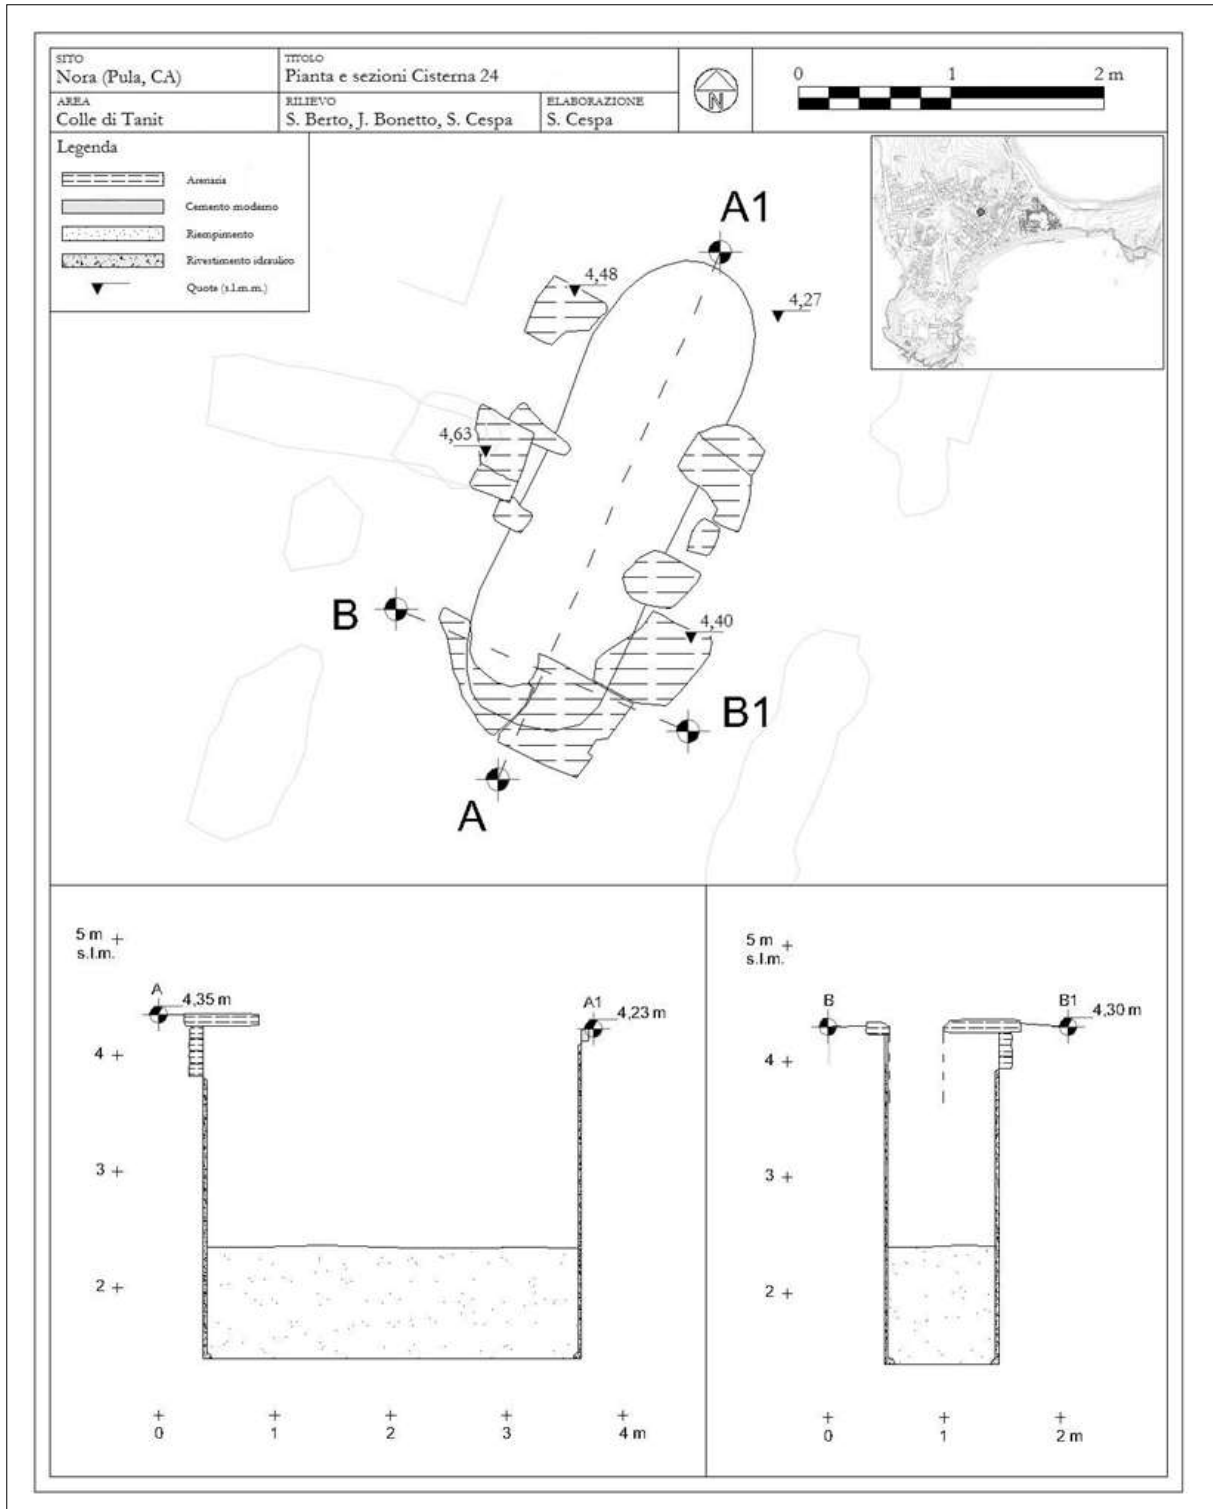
Pianta e sezioni della cisterna 24 (elaborazione dell'autore).
